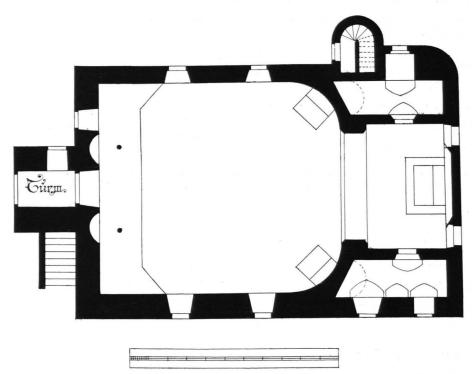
Franzen, Pfarrkirche, Grundriß 1:200 (S. 42)
